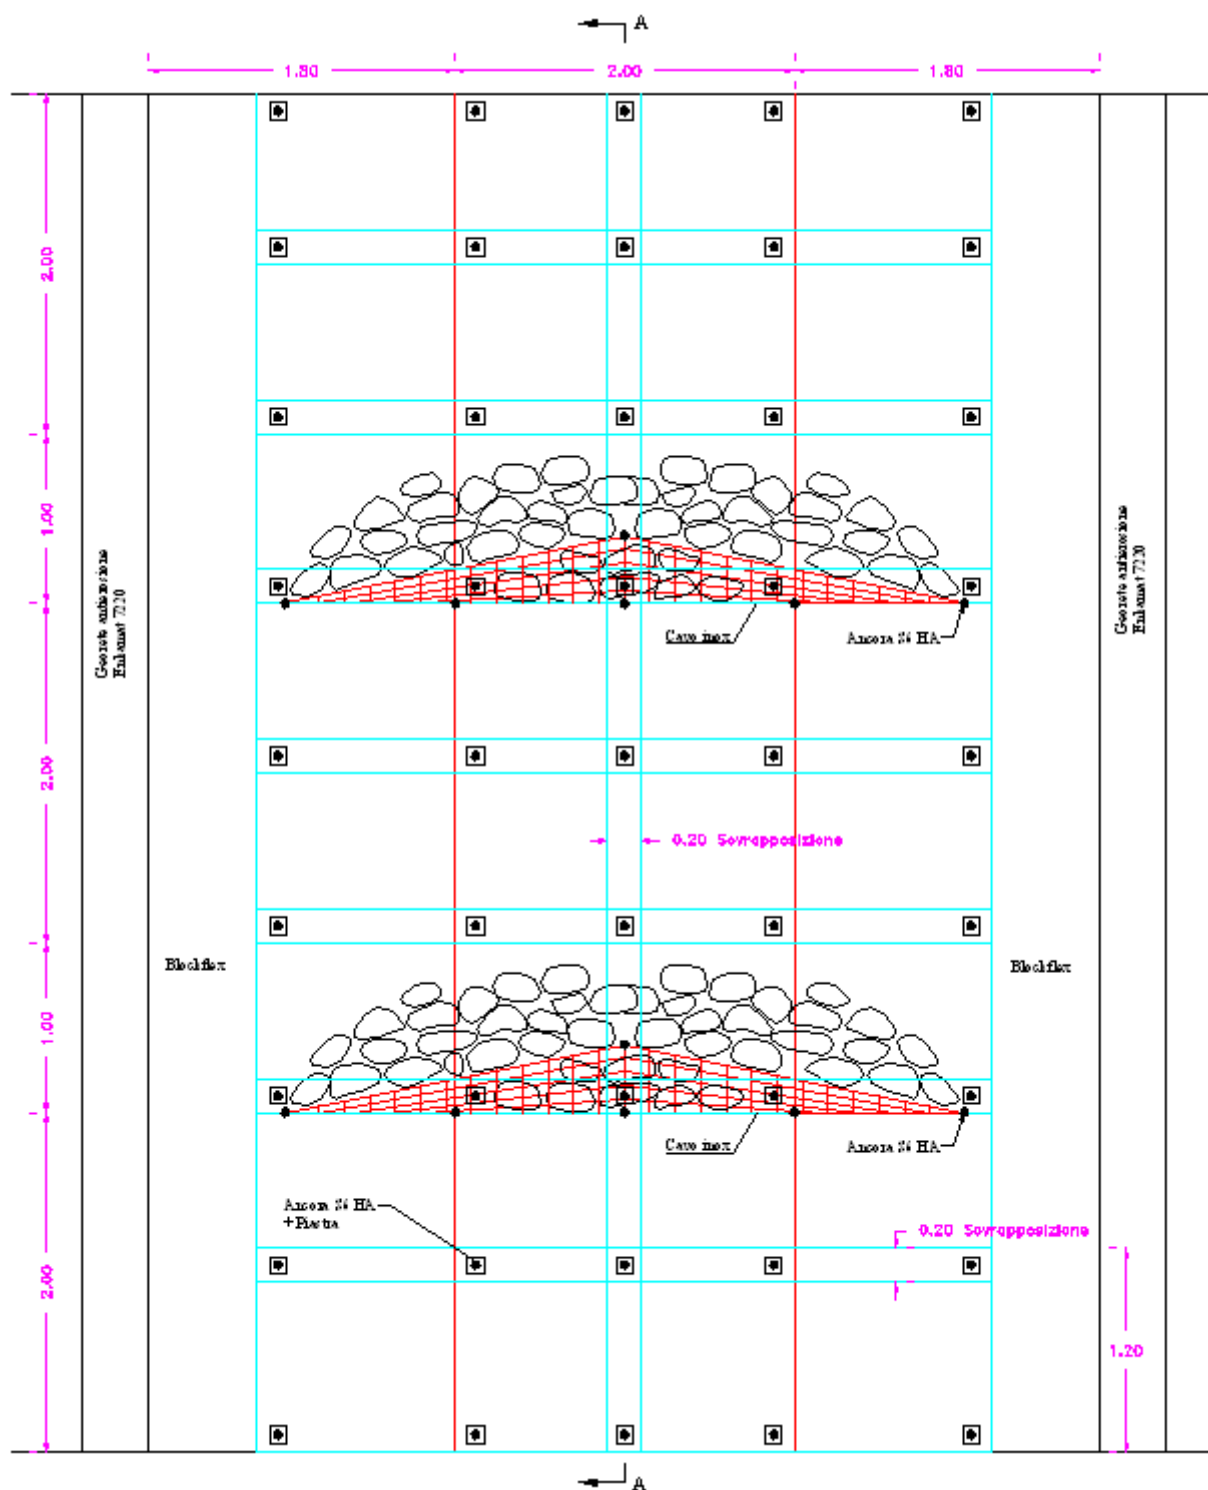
Pianta briglie con pietre e rete elettrosaldate
